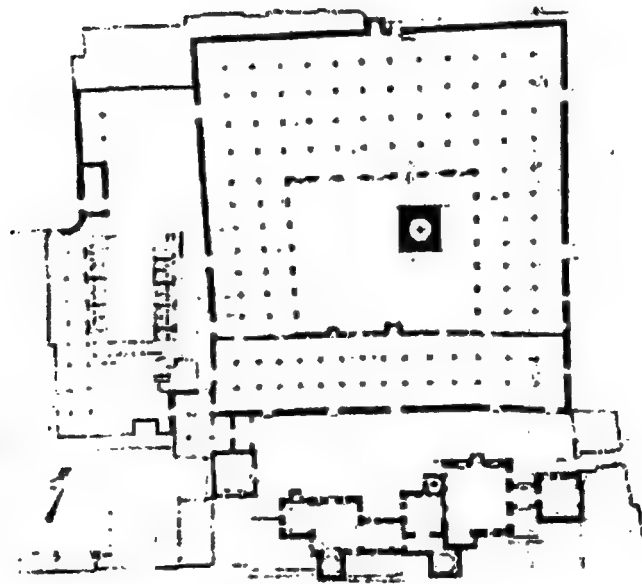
ب- مسقط أفقي للجامع الكبير بمدينة
